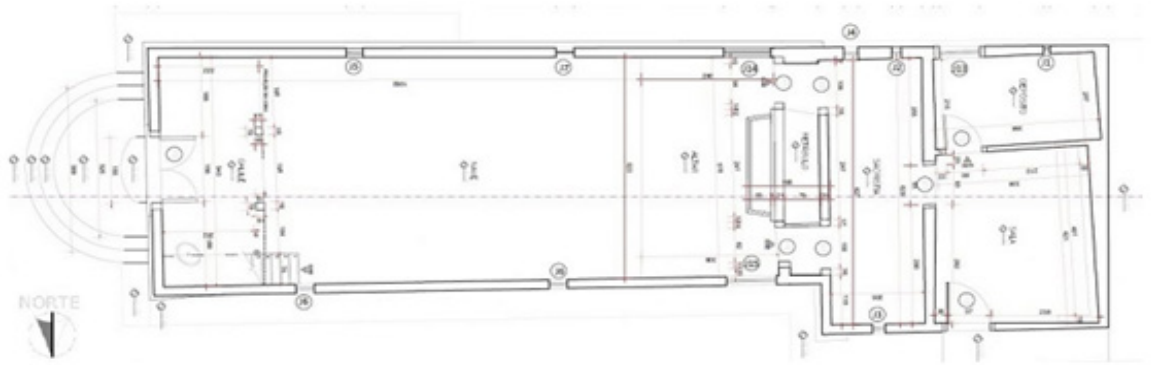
Planta parcial da Capela de Santa Teresa D'Ávila, em reprodução sem escala
